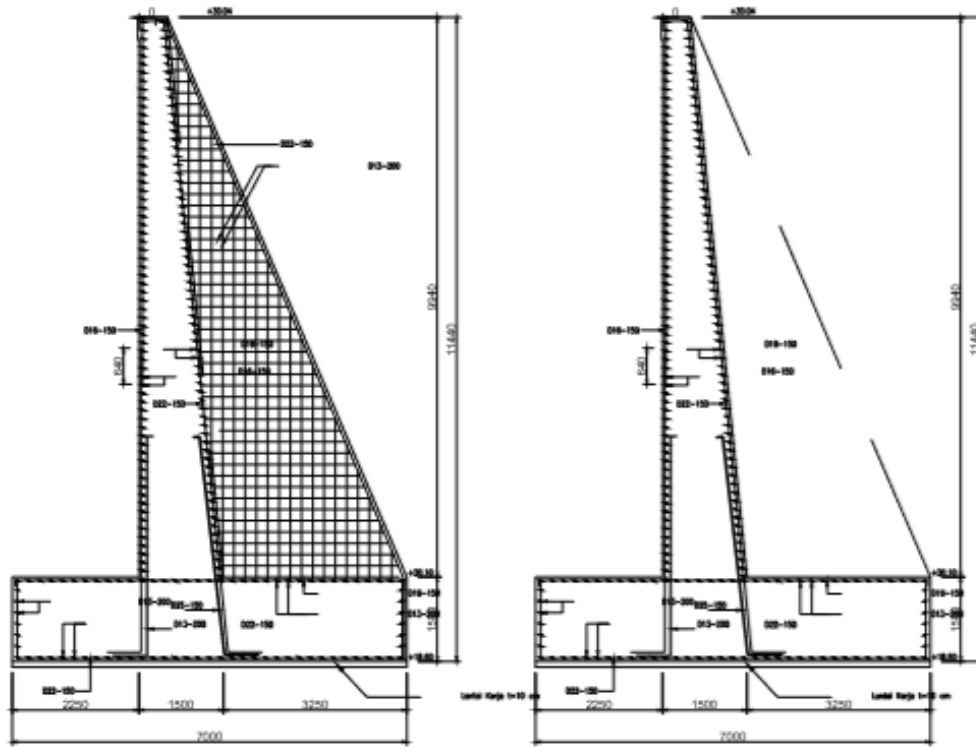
DETAIL PENULANGAN KONSTRUKSI DINDING PENAHAN TANAH TIPE B
